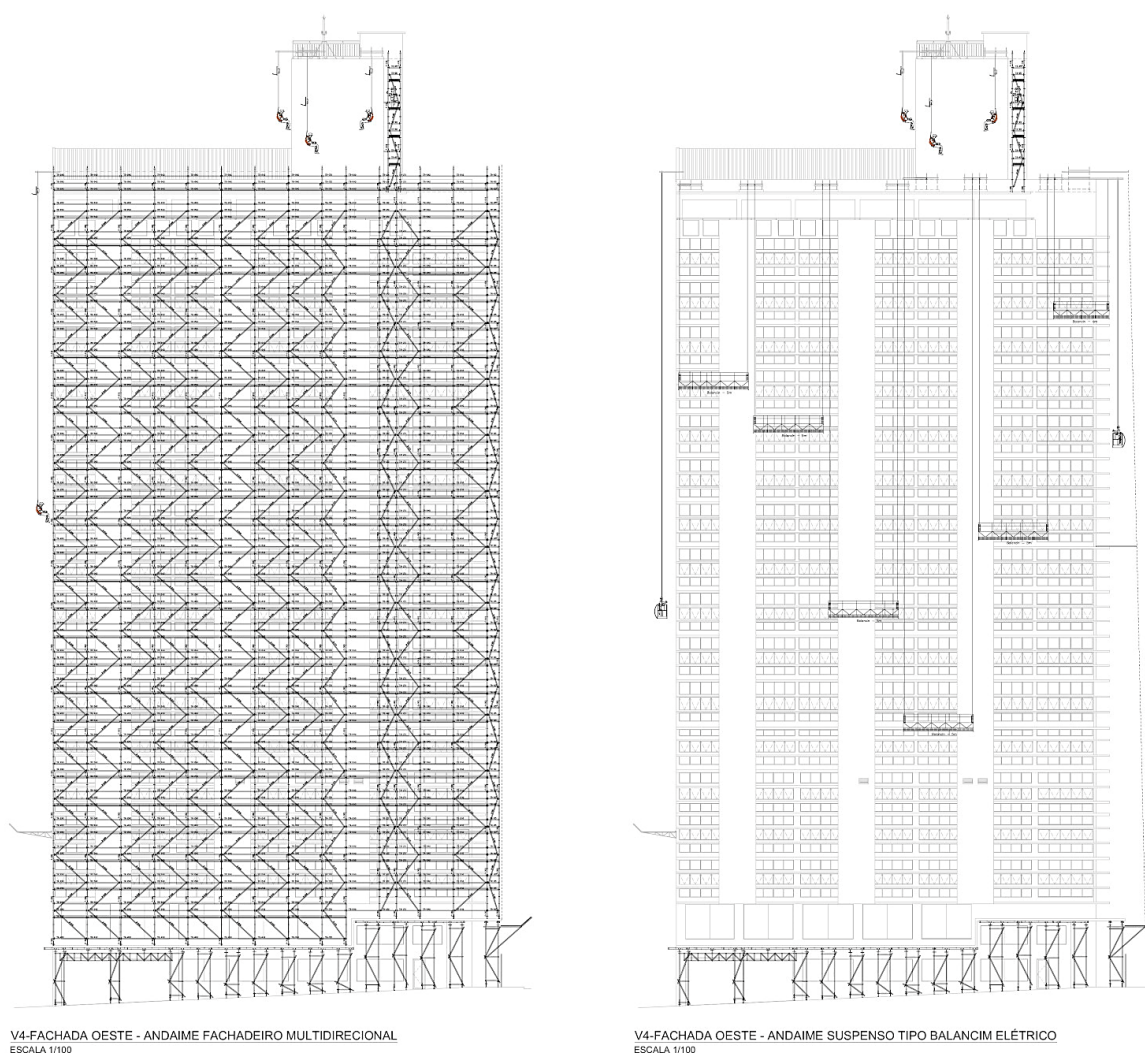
Sistemas de andaimes para serviços da fachada – Licitado X Proposto.
